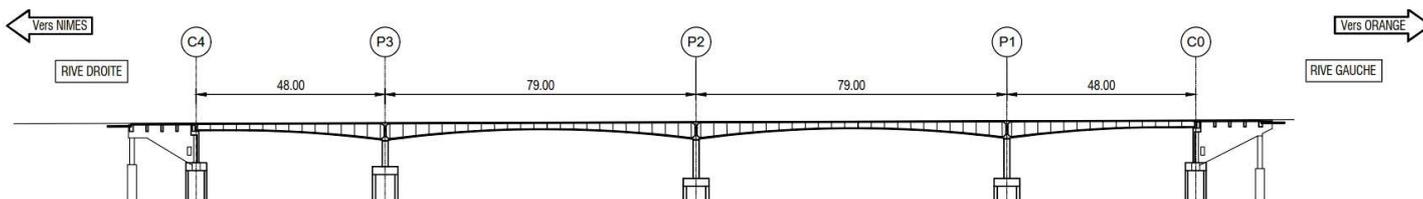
Coupe longitudinale de l'ouvrage (source : Arcadis MOE PRO)
